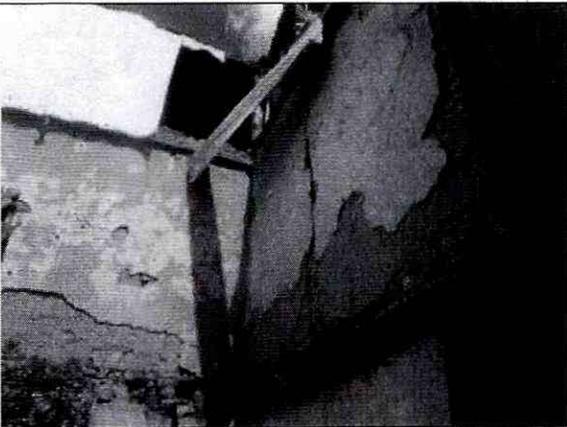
Primer piso. Detalle del cielo raso donde se observa colapso de loseta inferior.
